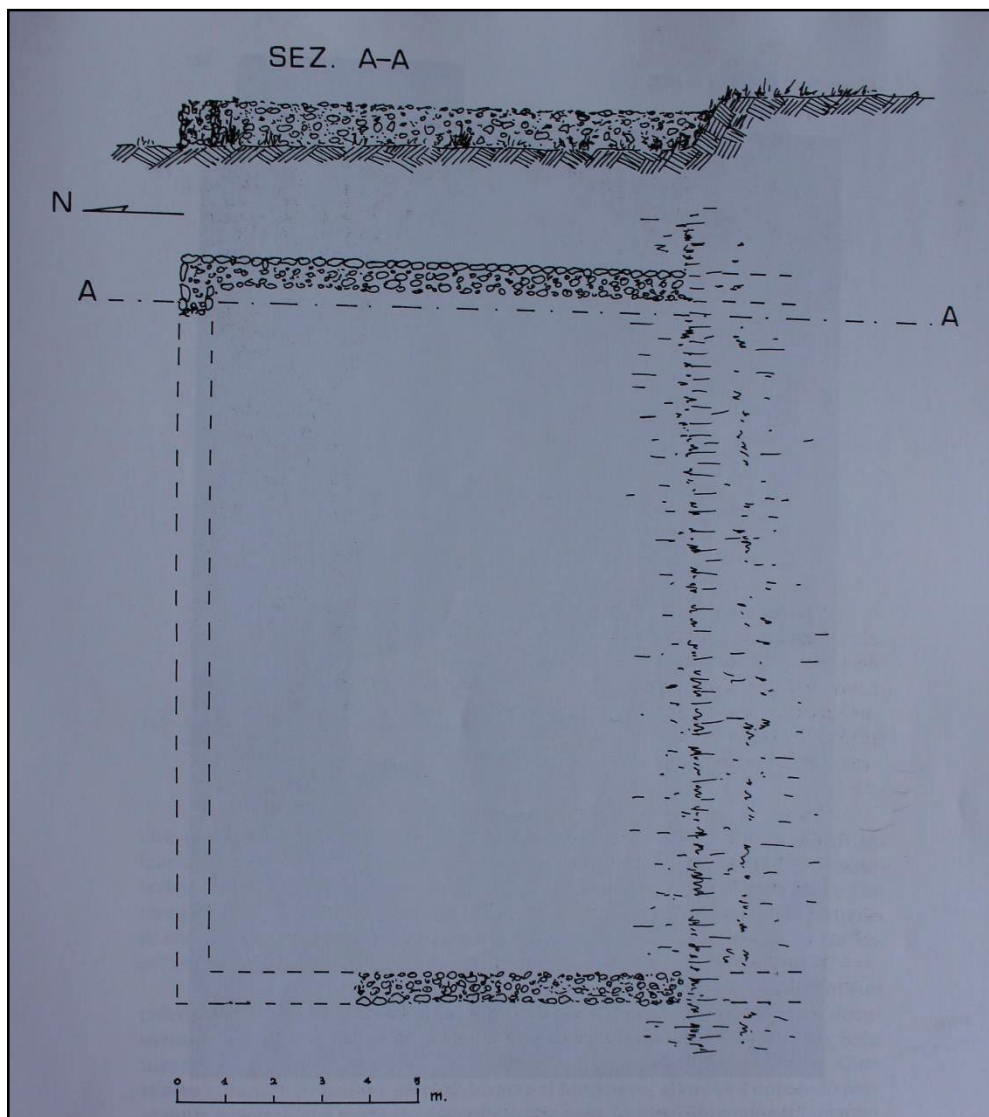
Pietramelara, S. Nicola: pianta e prospetto delle murature in opera cementizia (da: CAIAZZA 1995).
